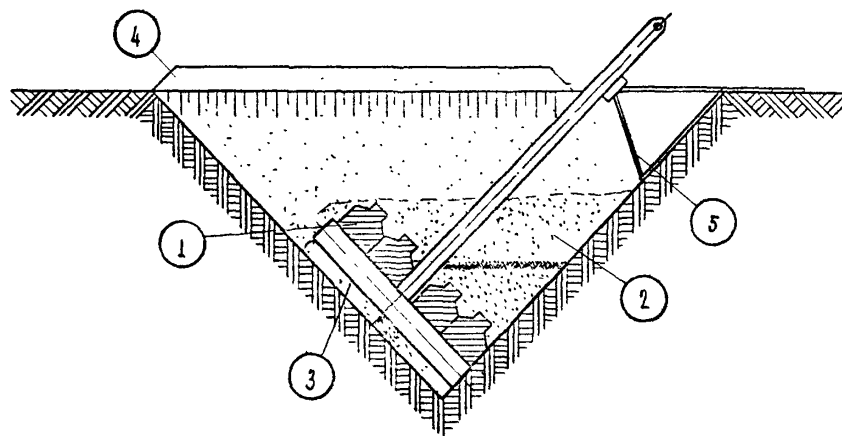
Последовательность монтажа анкерного фундамента. III этап.
